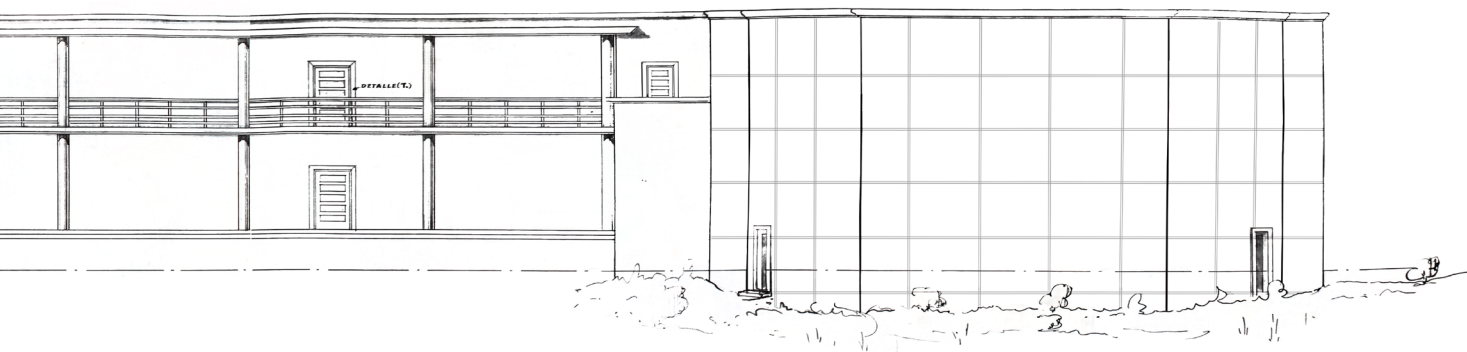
Alzado lateral y sección . Se observa la relación del bloque central (aulario) con el exterior mediante pórticos
